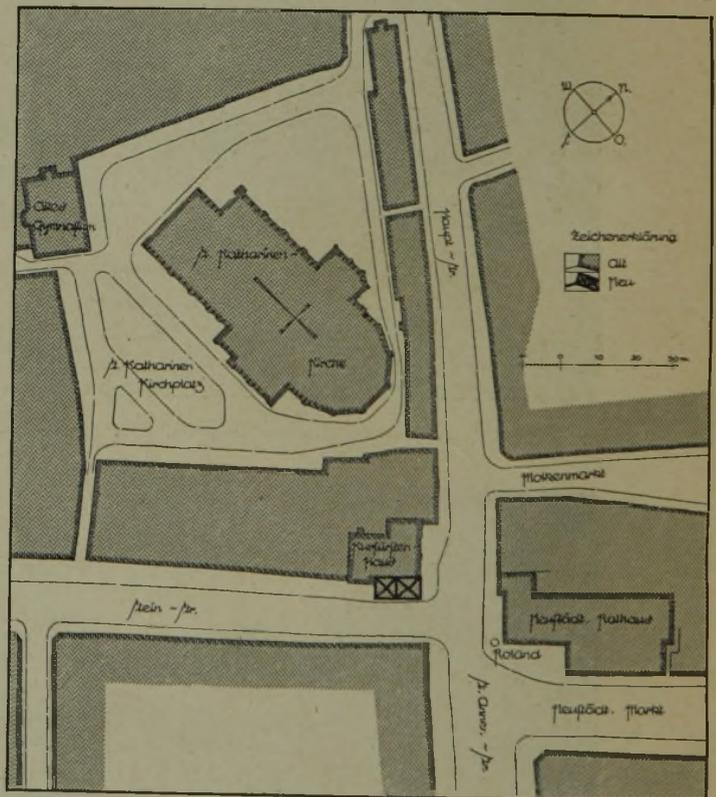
Lageplan des Kurfürstenhauses. 1 : 2000.
